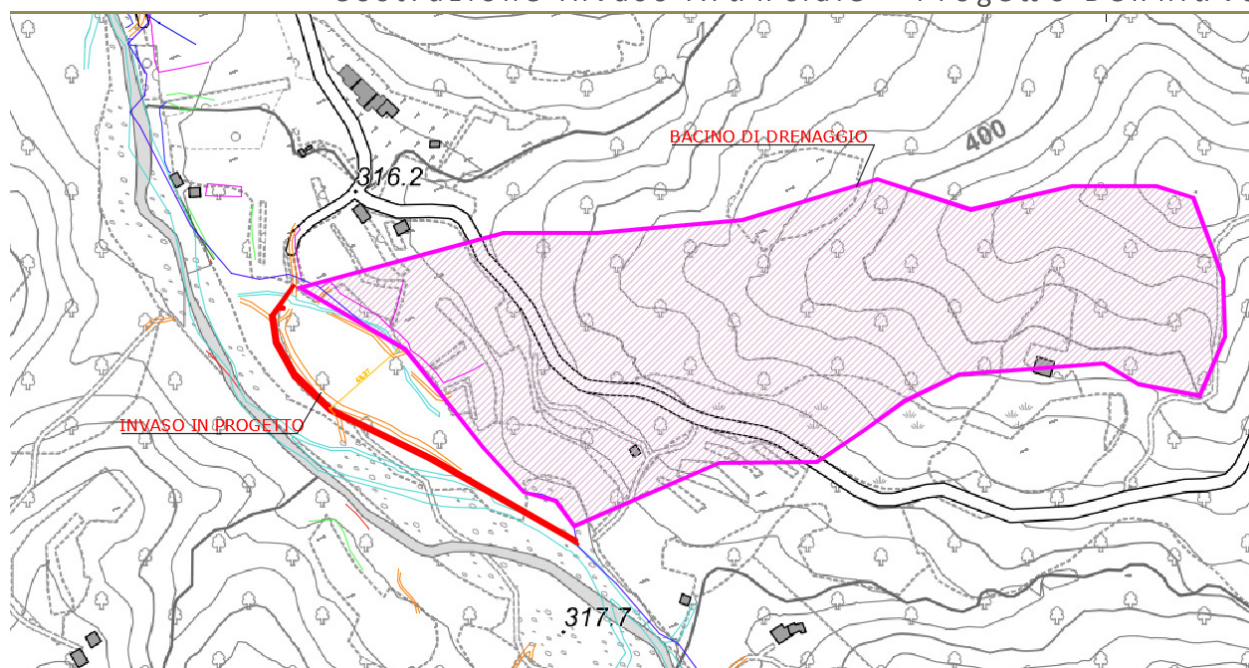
planimetria su CTR invaso in progetto e bacino di drenaggio.
